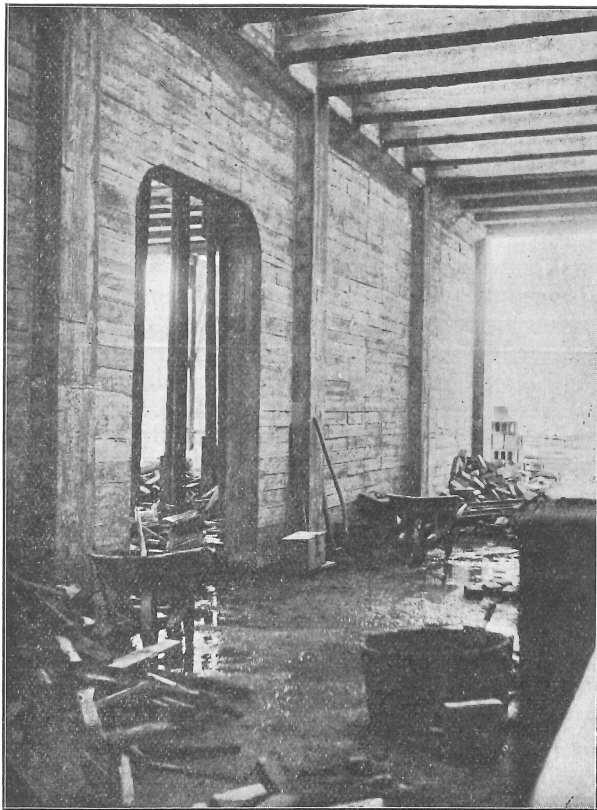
Poutre-cloison en béton armé de 20 m de portée (Institut du Génie Civil, 1934).
